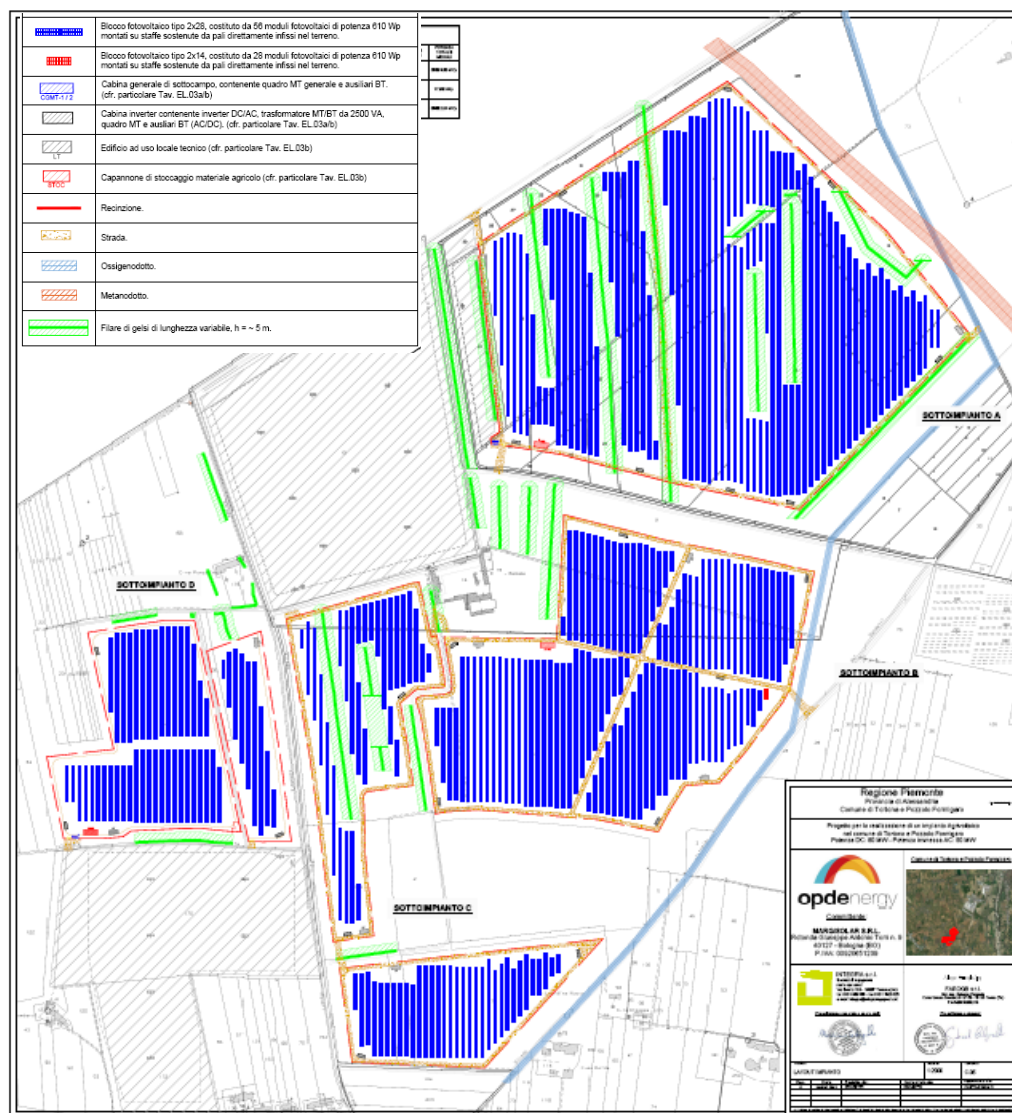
Suddivisione campi e configurazioni tracker (Rif. Tavola C05 Layout impianto)
